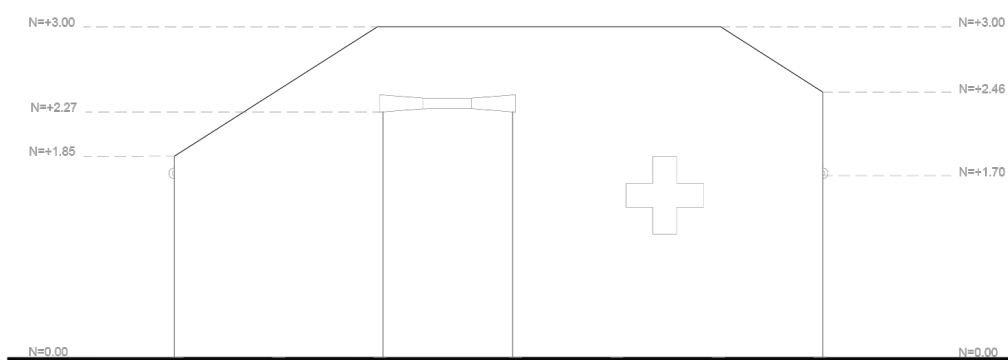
Planta arquitectónica tipo consultorios del habitáculo Modular Emergency Plant. Fuente y elaboración: Autores.
